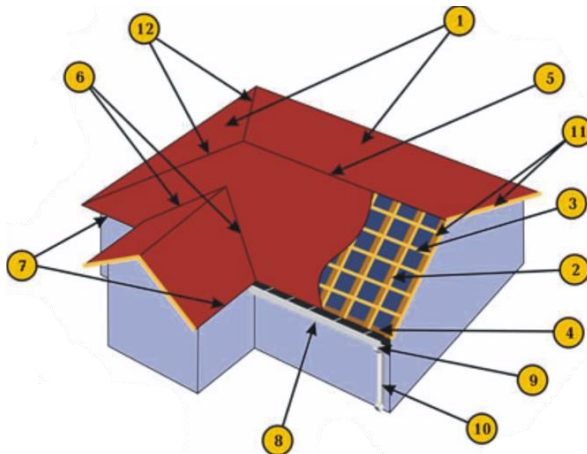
Схема конструкции кровли с деревянными наслонными стропилами: 1 – скаты; 2 – стропильные ноги; 3 – обрешетка; 4 – мауэрлат; 5 – конек; 6 – свесы; 7 – карнизные свесы (минимум 500 мм); 8 – настенные желоба; 9 – водоприемные воронки; 10 – водосточные трубы; 11 – фронтовые свесы
